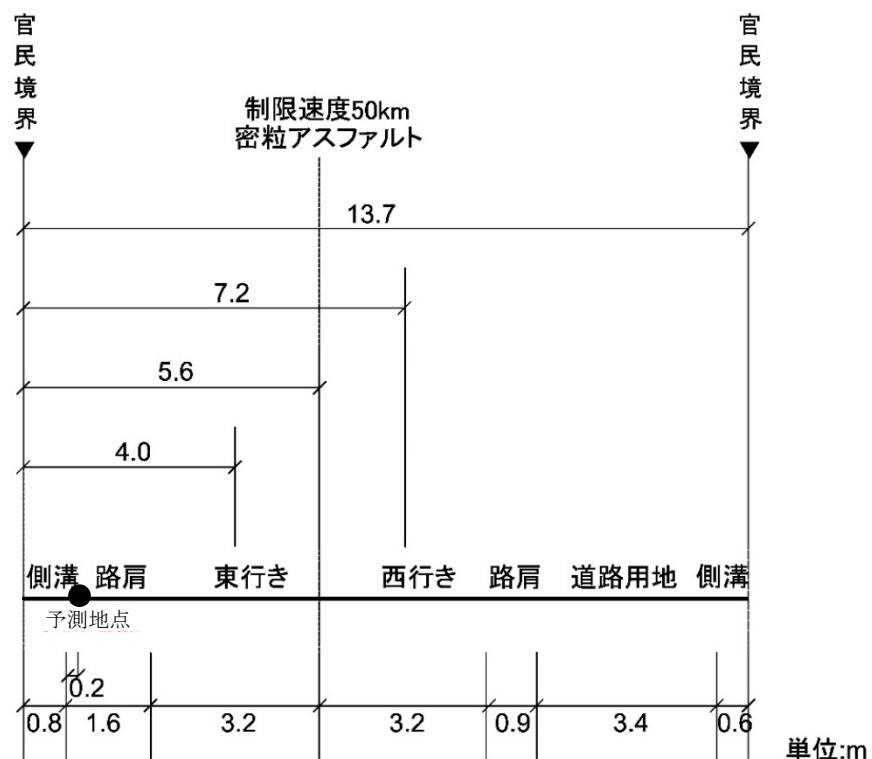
予測断面図 (黄瀬 県道 16 号大津信楽線)
